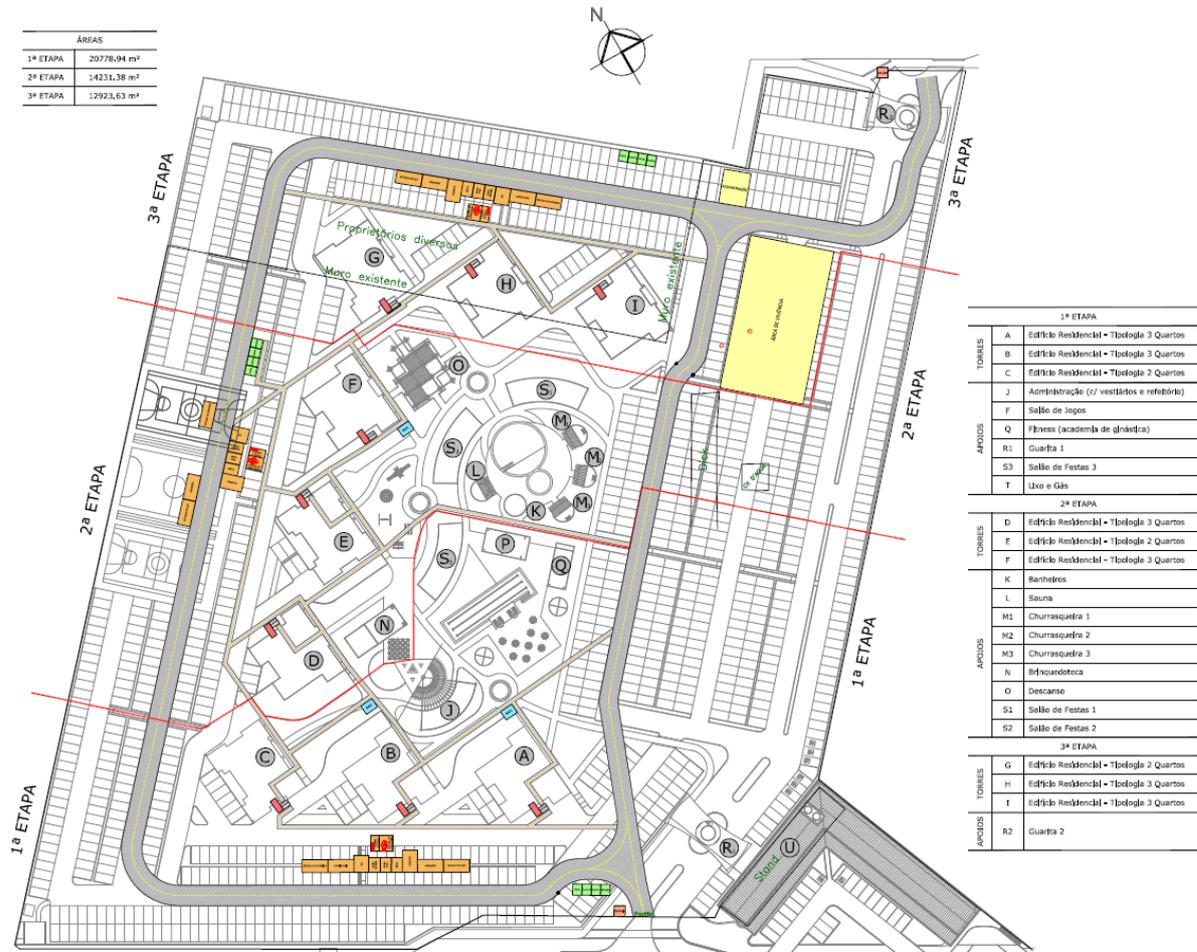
Layout Geral do Sistema de Produção (Autor, 2014)
